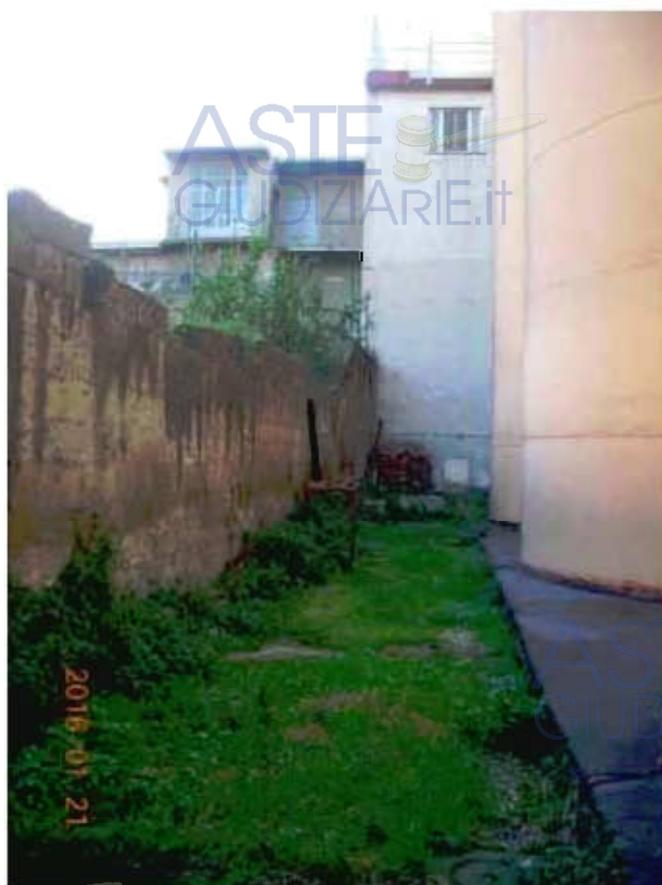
Muro di separazione tra la particella 194 e il suolo
